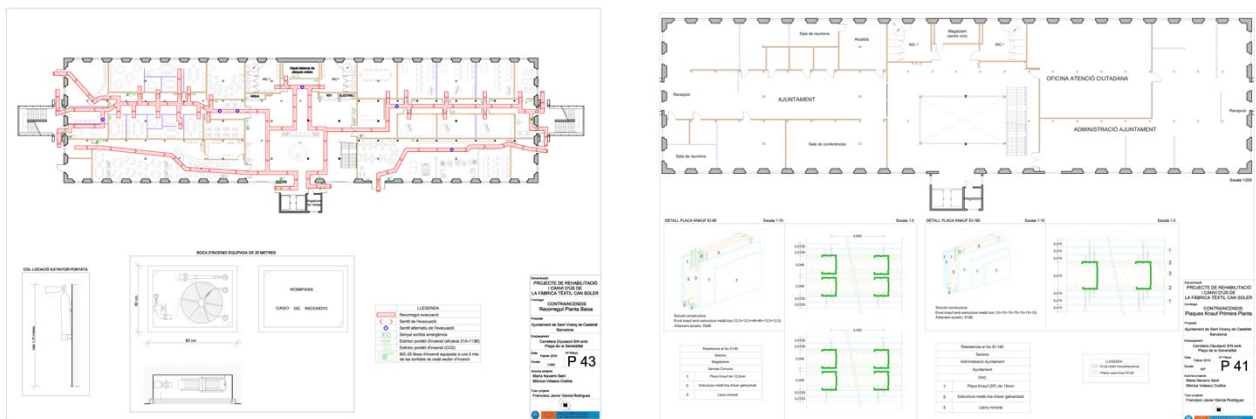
Reproducción planos instalaciones y detalles constructivos
